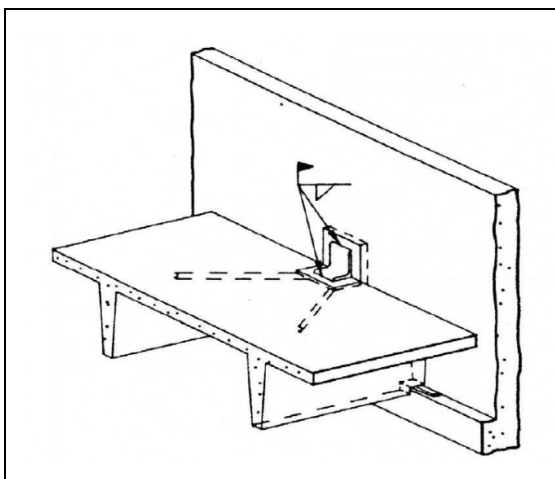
Ligação de lajes duplo “T” em vigas “L”, com chapas soldadas, assentes em neoprene, perpendiculares à laje de piso (PCI)
